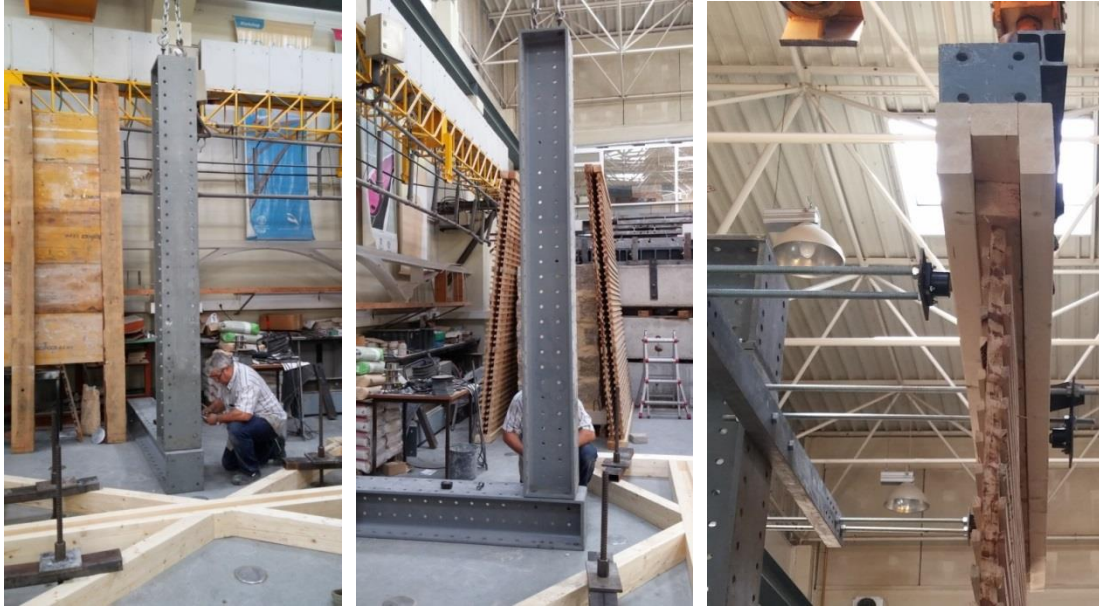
Pórtico metálico que contém o braço que impede o deslocamento do cabeço da parede para fora do plano da parede
